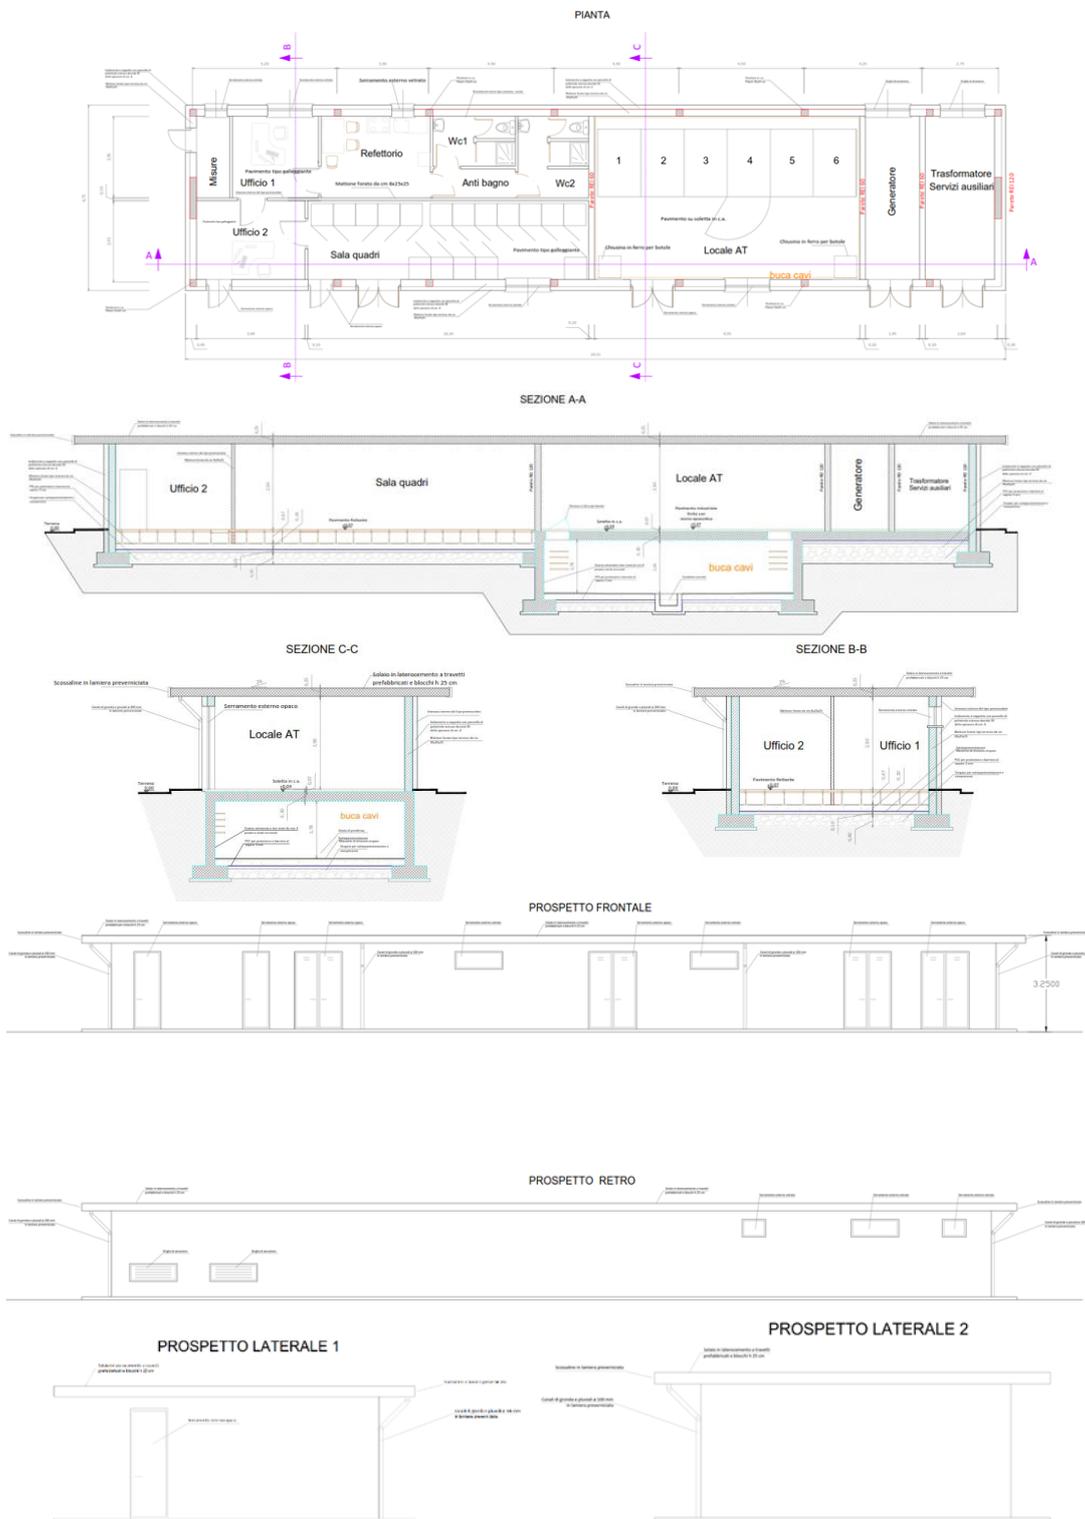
Planimetria e sezioni della SSE di raccolta e controllo
